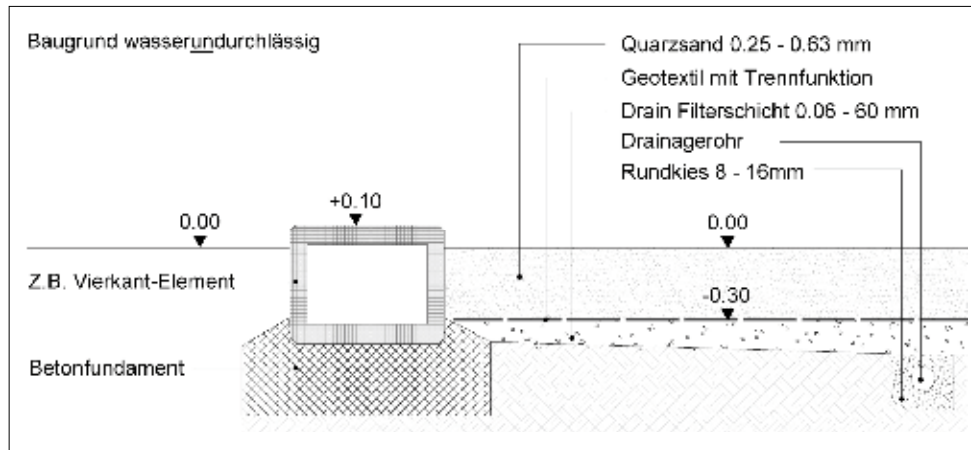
Systemaufbau für wasserundurchlässigen Baugrund
